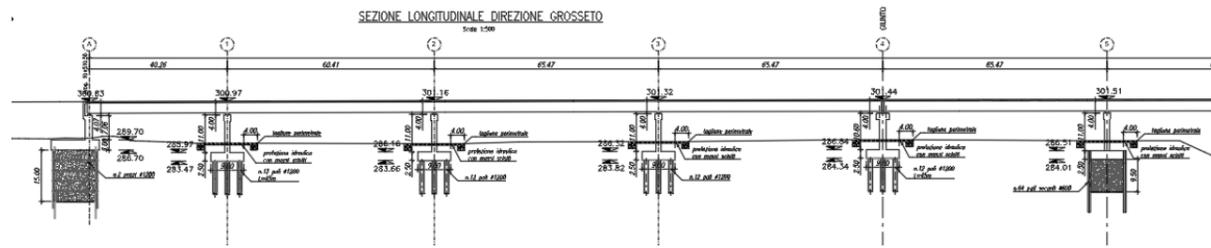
Sezione longitudinale carreggiata direzione Grosseto
